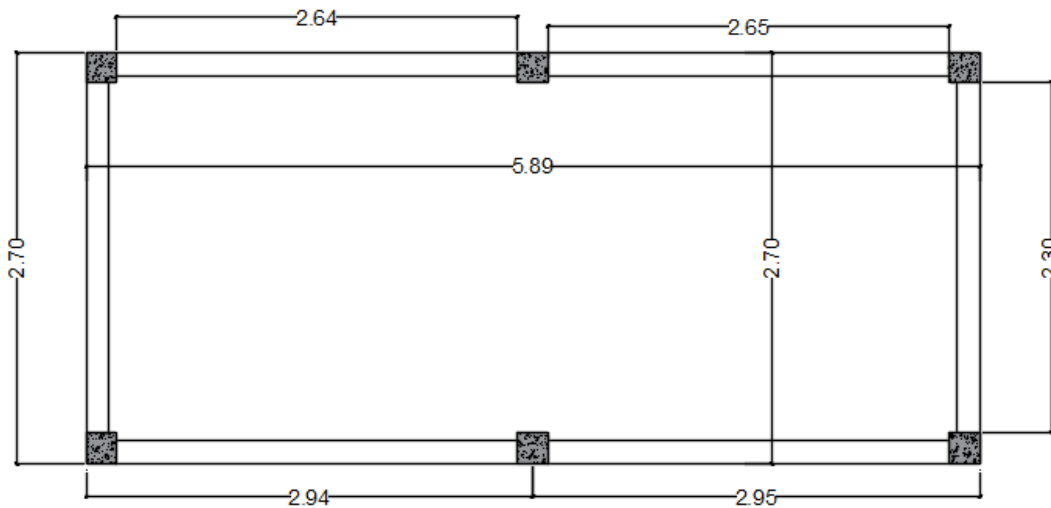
Planta de disposição dos pilares da caixa d'água (medidas em metro).
